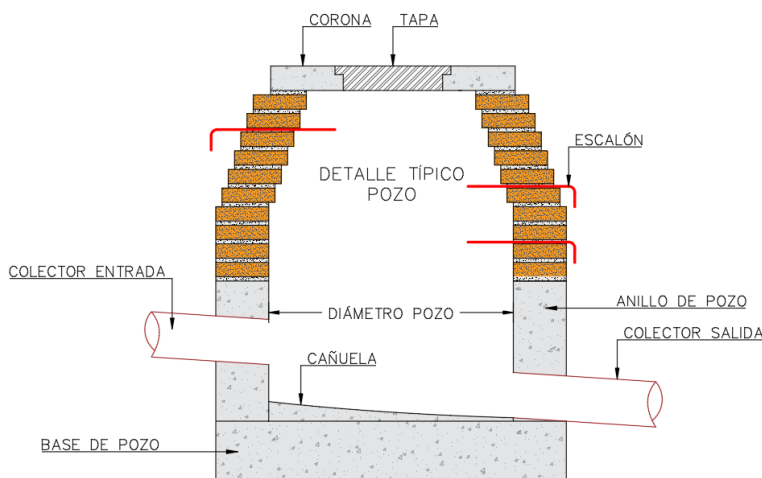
Detalle típico de pozo de inspección. Autores del proyecto.
